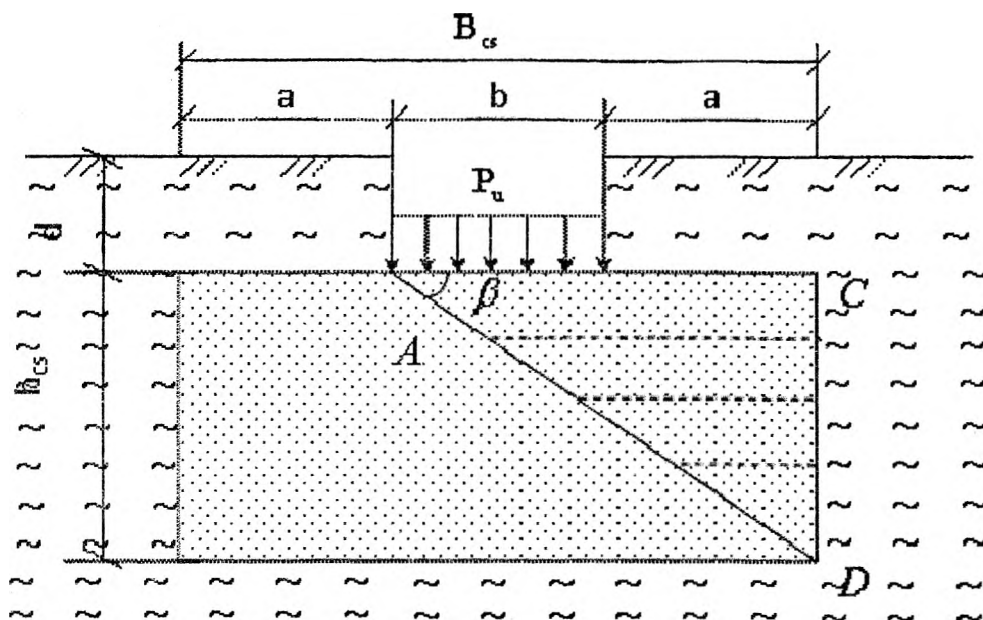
Схема к расчету армированной грунтовой подушки
